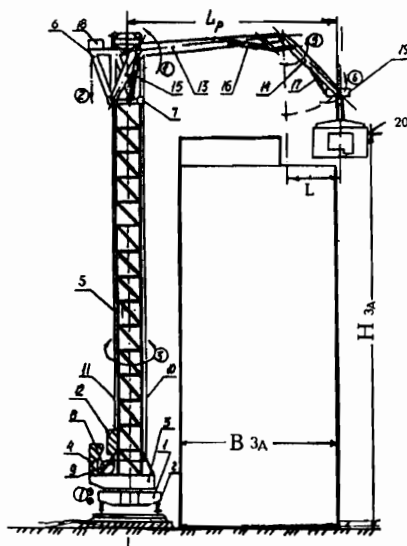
Башенный кран-манипулятор с рабочим оборудованием "стрела-рукоять" и рабочим органом для жесткого захвата: 1 - платформа; 2 - ходовая тележка; 3 - поворотная платформа; 4 - противовес устойчивости; 5 - башня; 6 - обойма; 7 - опора качения; 8 - грузовая лебедка; 9, 10 - трос; 11 - трос противовеса; 12 - противовес рабочего оборудования и половины массы груза; 13 - корневая часть стрелы; 14 - рукоять; 15, 16 - гидроцилиндры стрелы и рукояти; 17 - гидроцилиндр поворота рабочего органа; 18 - привод гидроцилиндров; 19 - рабочий орган; 20 - монтируемая конструкция;  $L_p$  - вылет рабочего органа;  $L$  - вылет рукояти;  $B_{зд}$ ,  $H_{зд}$  - ширина и высота здания
